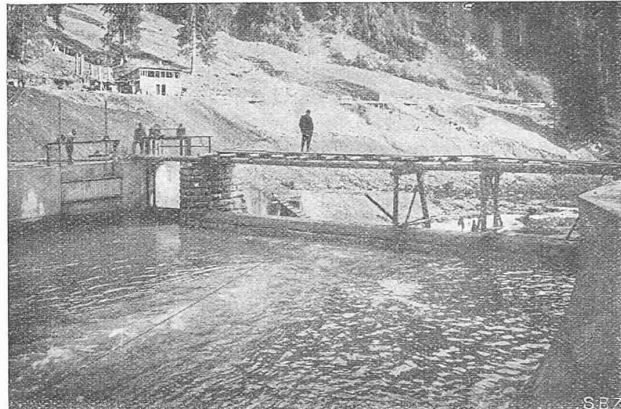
Wehr mit Grundablass und Einlauf (21. Sept. 1921).
